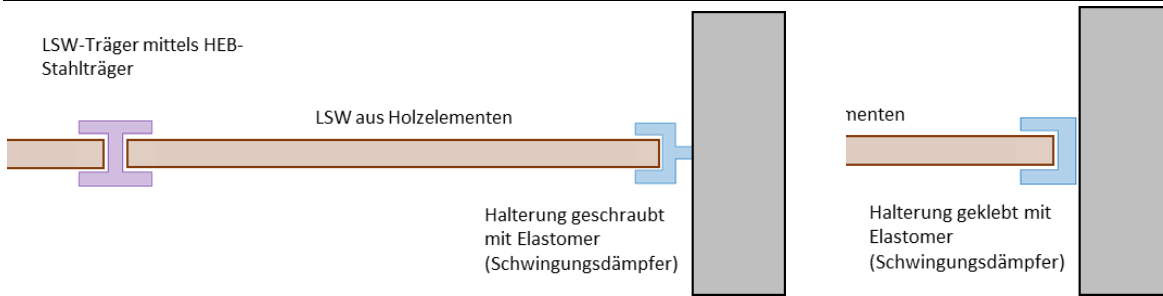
Detail Anschluss an UEF SBB im Sand (link: geschraubte Halterung, rechts: geklebte Halterung)
